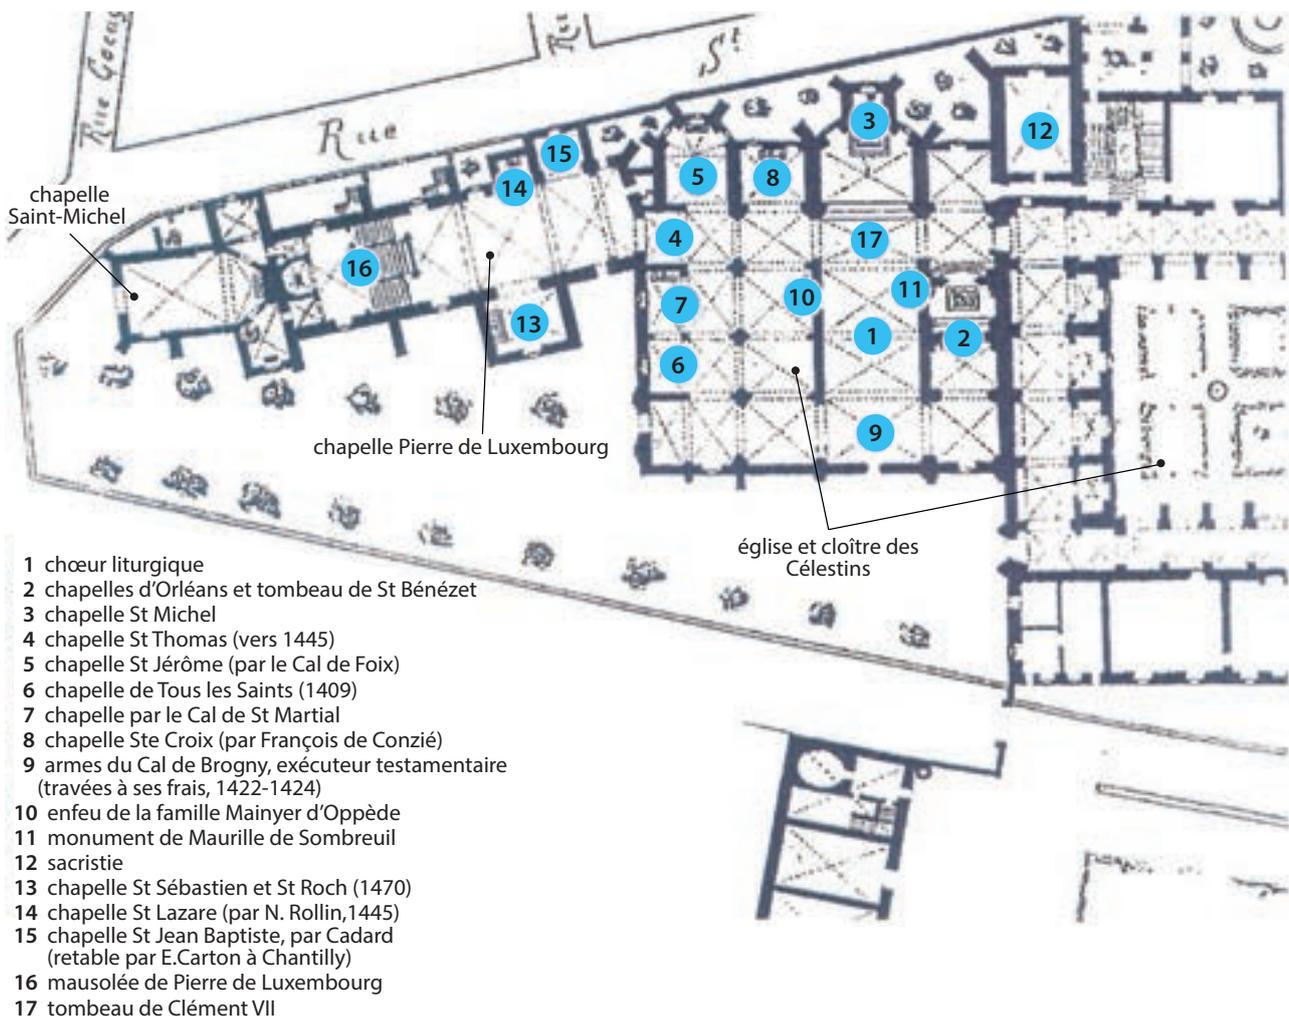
AVIGNON, 33, place des Corps-Saints. Reconstitution du couvent des Célestins d'après le plan du capitaine Pampany et les travaux d'Alain Breton.
